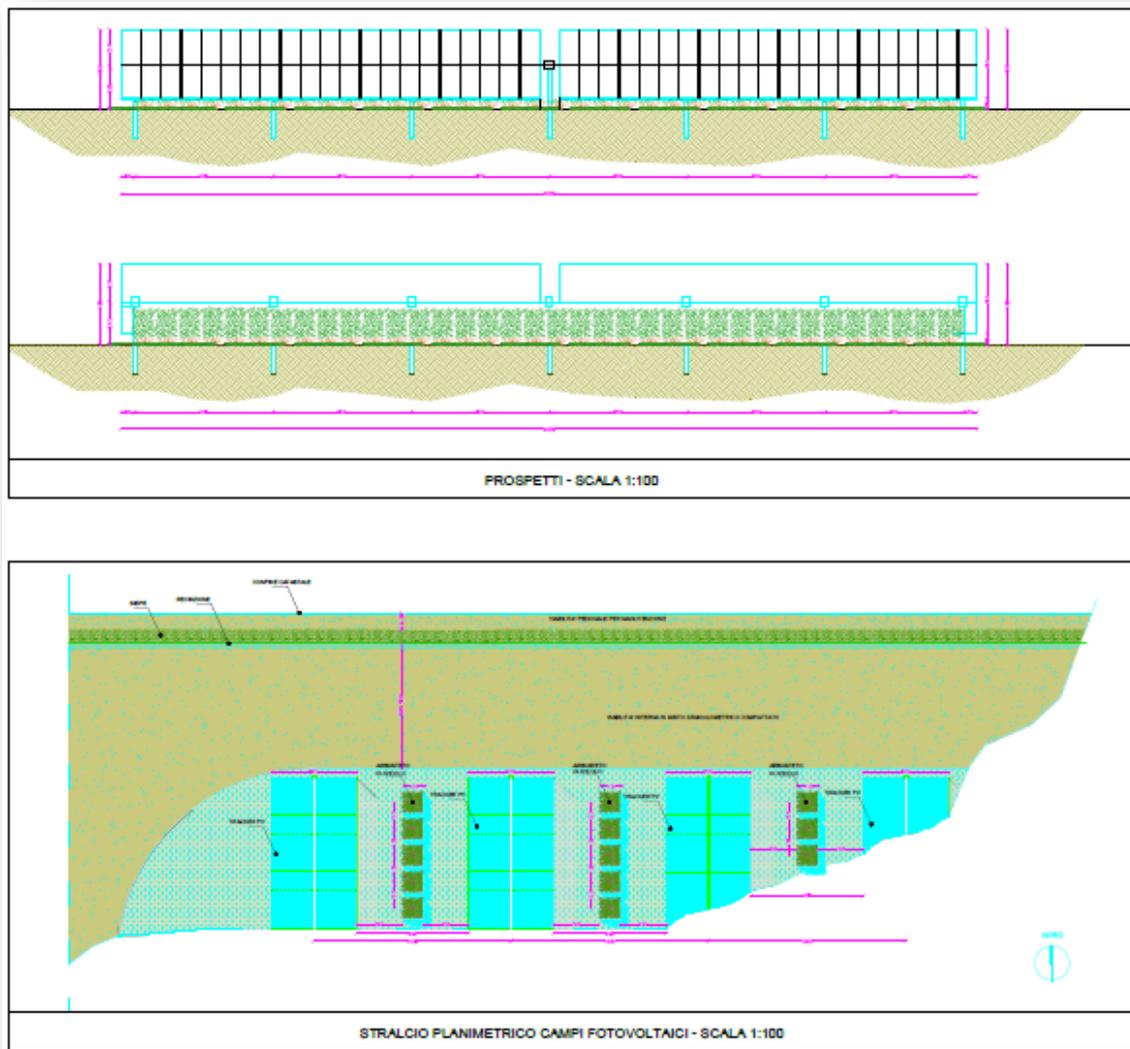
Estratto elaborato MBFAF96\_Elaborato\_Grafico\_R.5.a. (Stralcio Planimetrico e prospetti)
